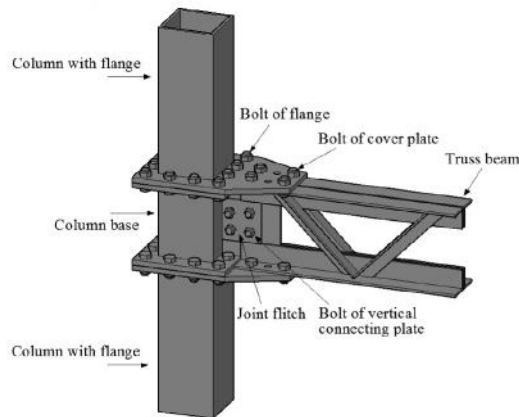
Diagrama estructural de la conexión. Vista detallada de los elementos que la componen[6].
